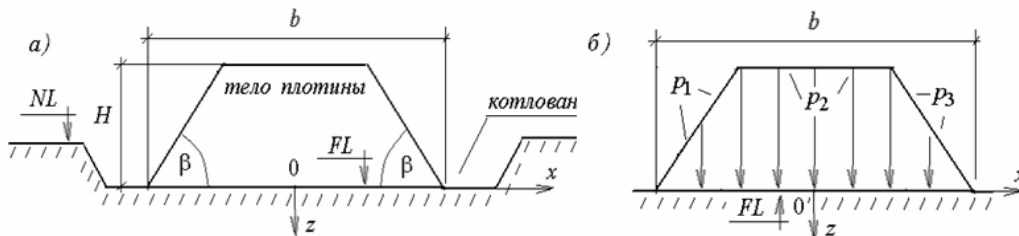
К определению нагрузки на основание от веса плотины. а – фактическая схема; б – то же, расчетная
